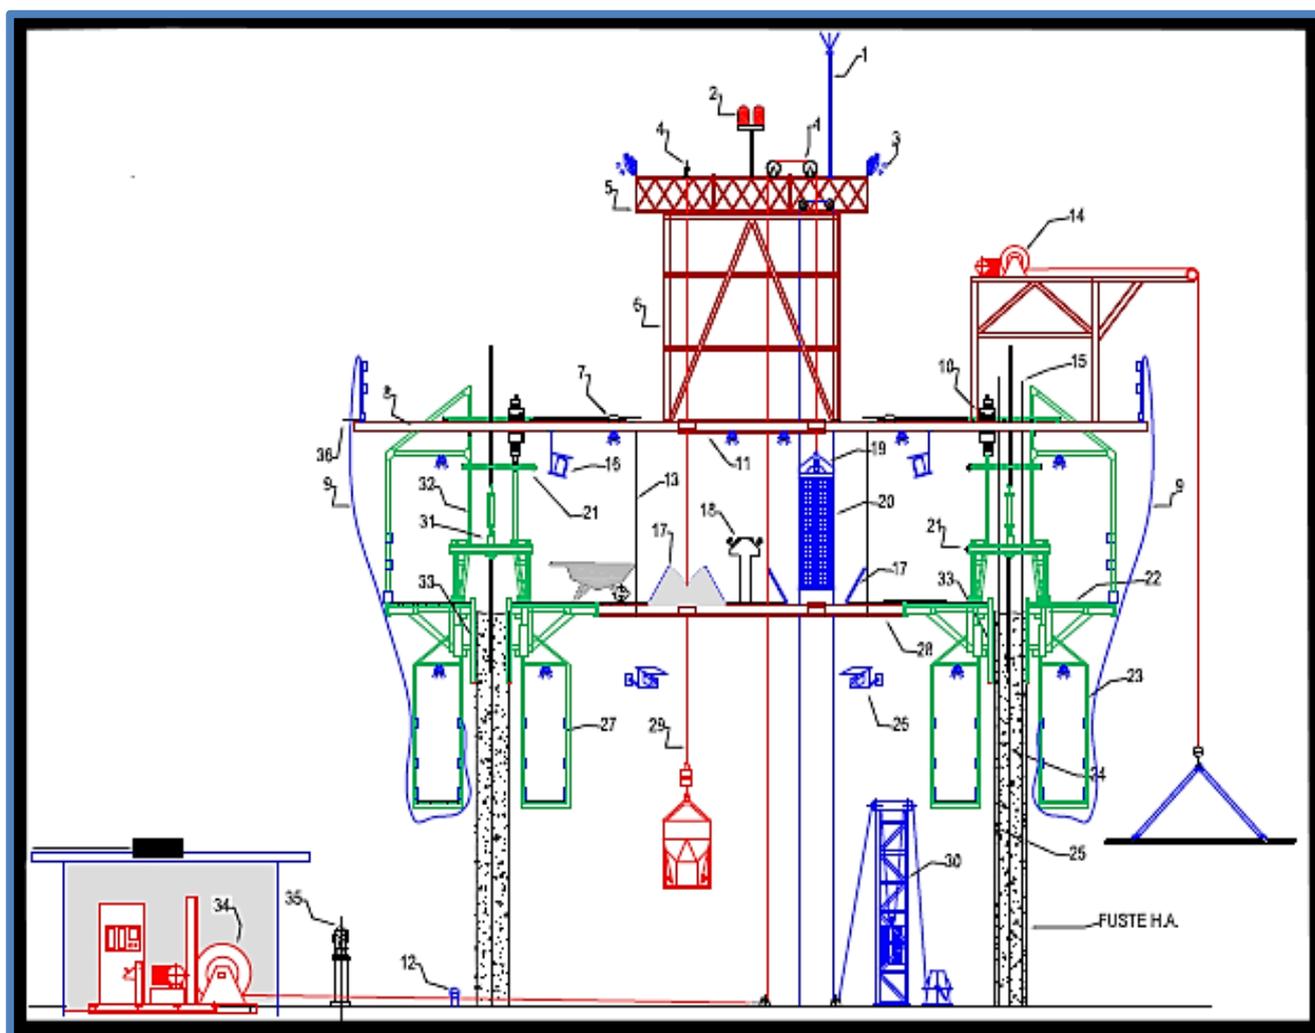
Encofrado Deslizante – Sistema Constructivo “Tipo”.
